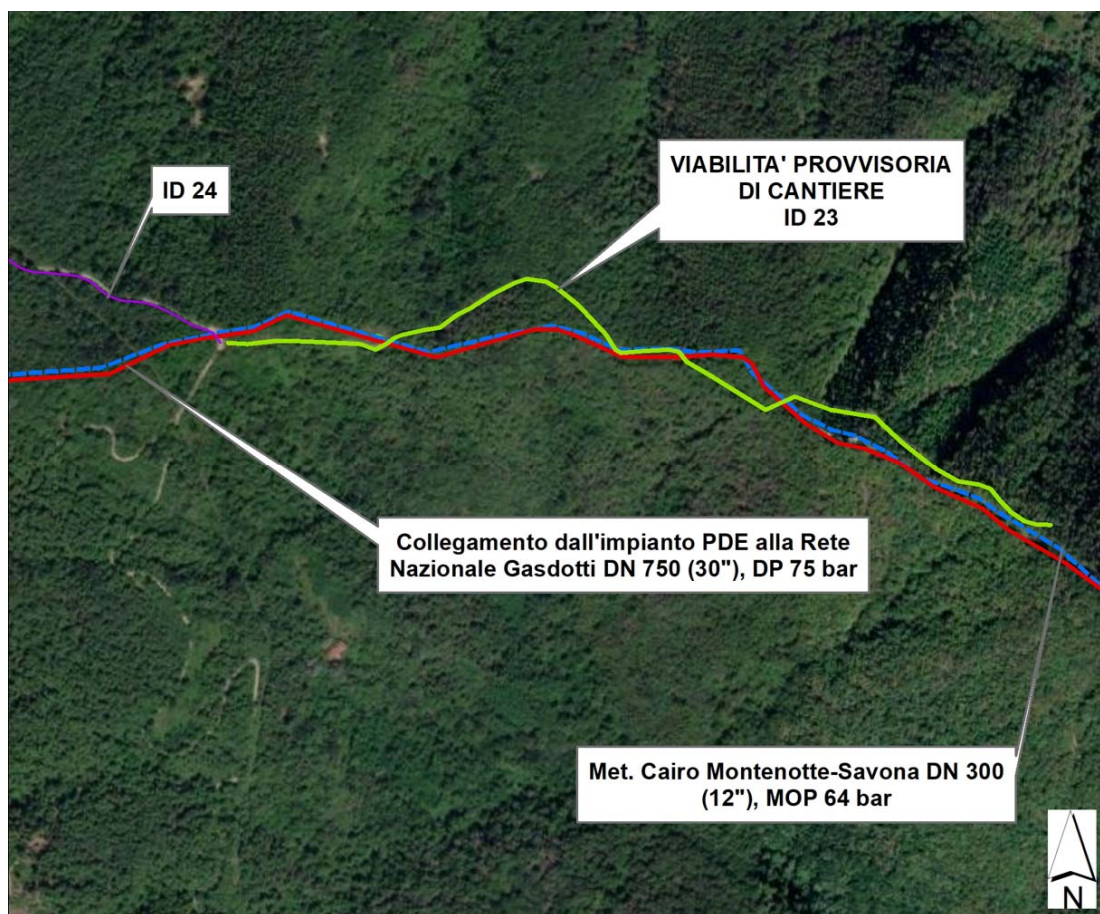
Planimetria di inquadramento della strada provvisoria di cantiere ID23
